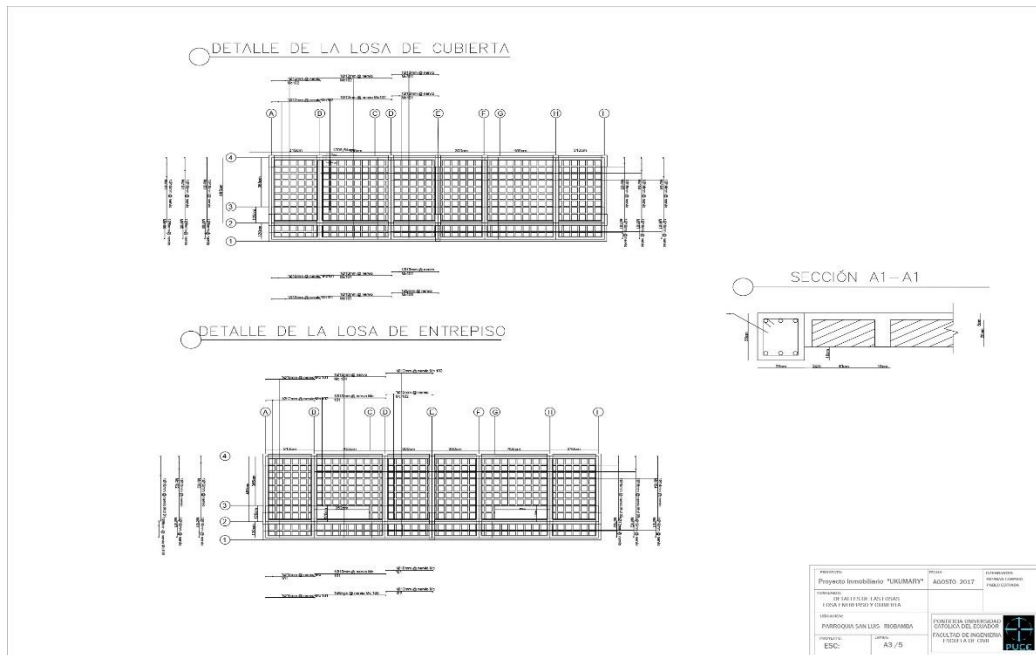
Detalle de planos estructurales - losas– Fuente: Carphio (2017)
